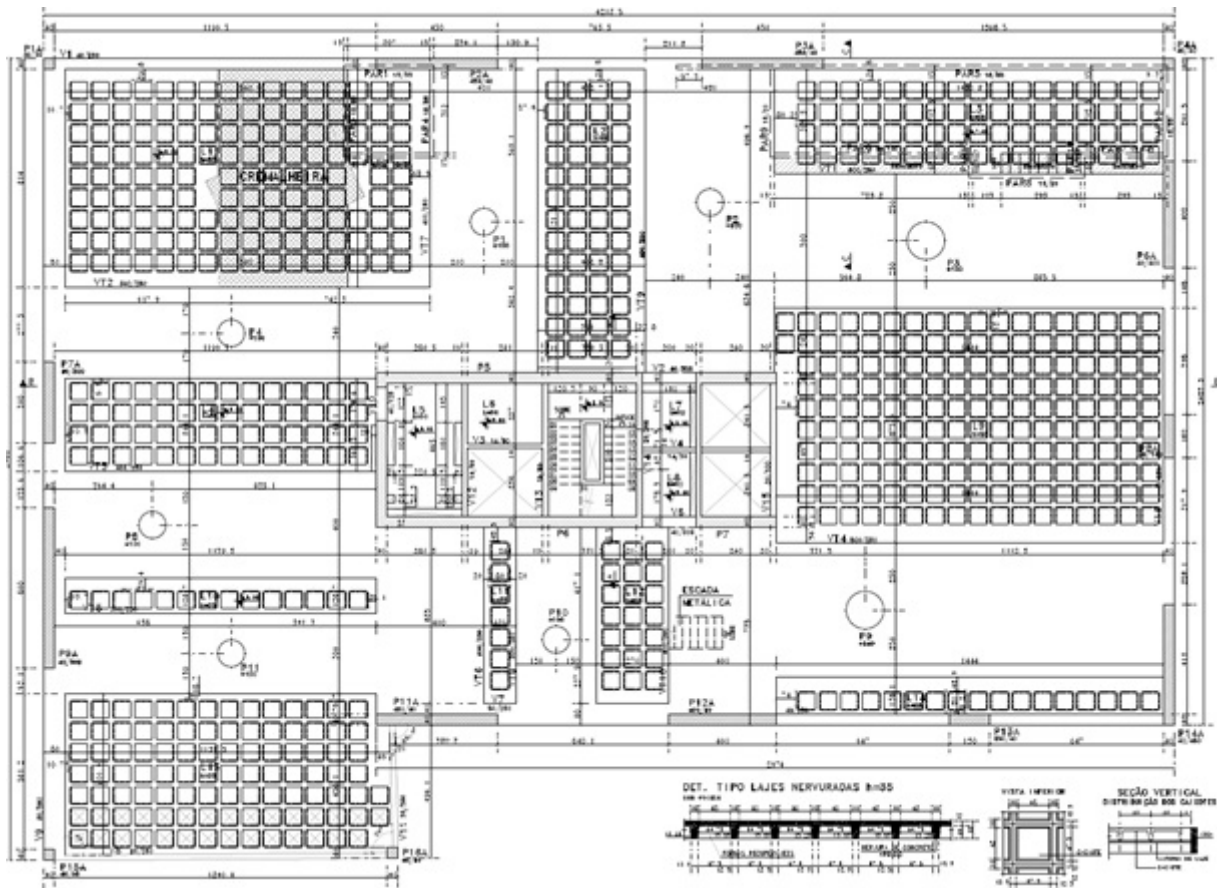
Forma do pavimento de transição (Roof Garden)
